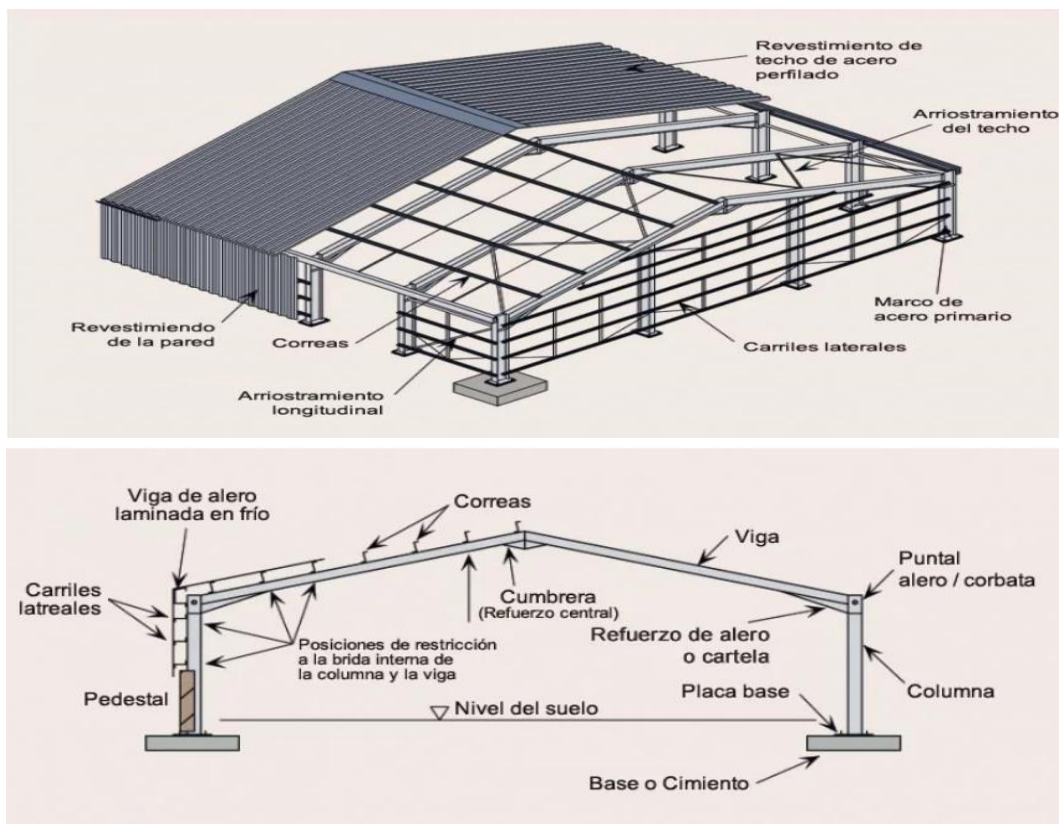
Partes que conforman las estructuras metálicas y sus montajes.
